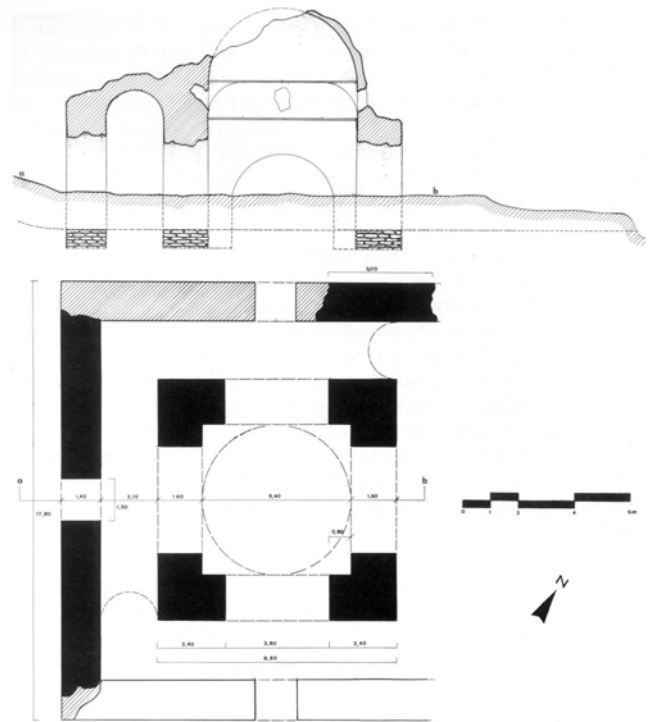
Grundriss/Schnitt Čahār Jāq/Seh Pa
